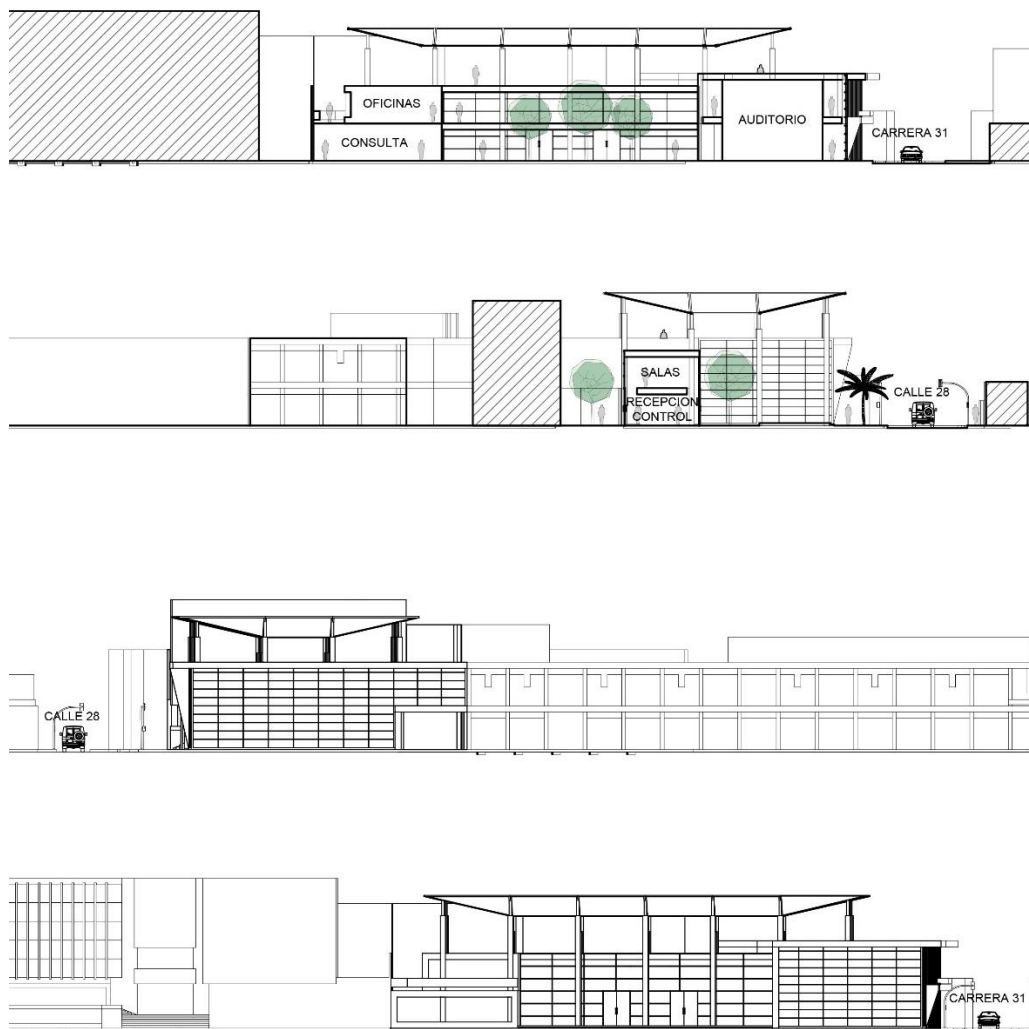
Cortes y fachadas esquema básico edificio Archivo General e Histórico de Palmira. Fuente Propia.
